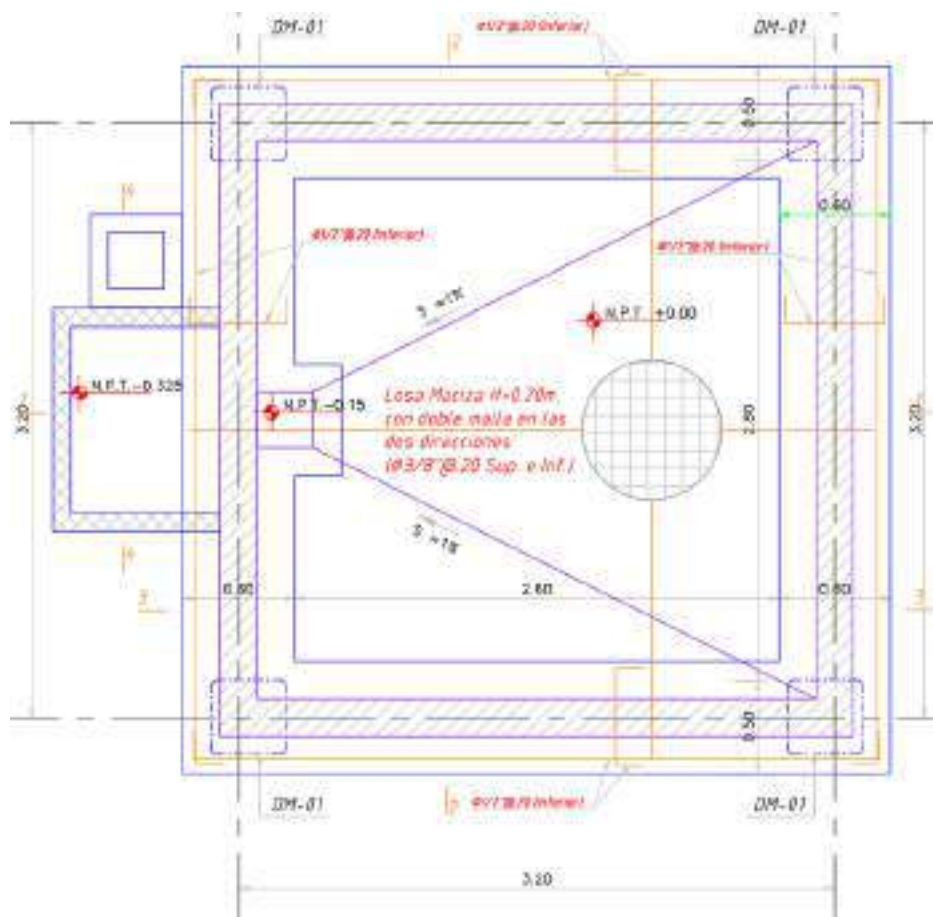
Distribución de acero en la losa de fondo del Reservoirio V=10.00 m3.
